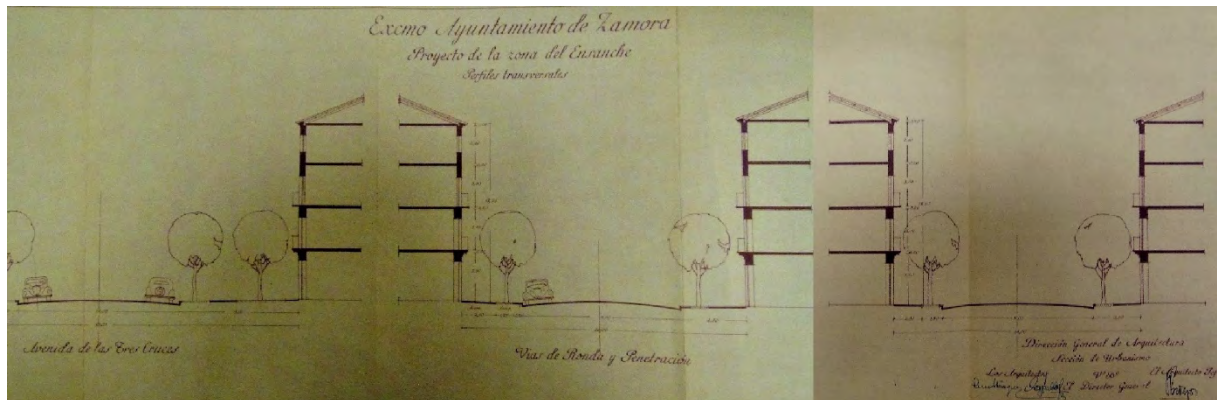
Sección de vía y tipo edificatorio correspondiente a la avenida Tres Cruces y ronda principal del Plan General de Ordenación del Ensanche de Zamora. Dirección General de Arquitectura (1942-1943).
